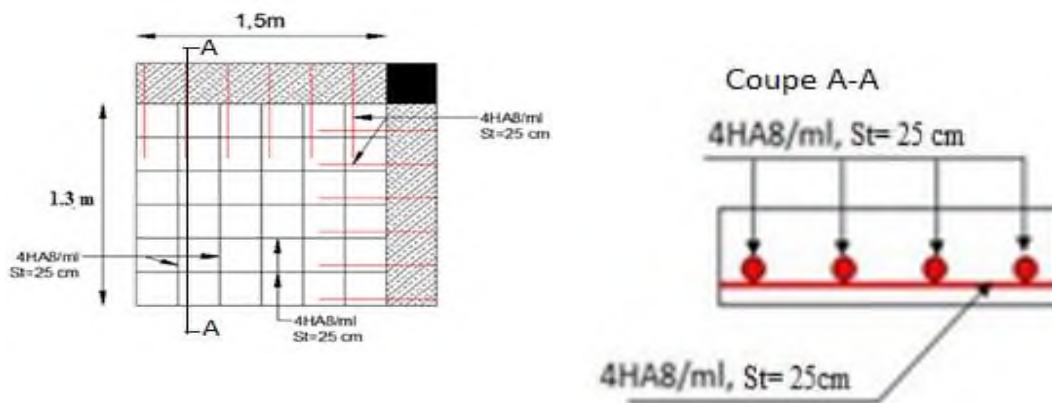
Schéma de ferrailage de la dalle sur 2 appuis
